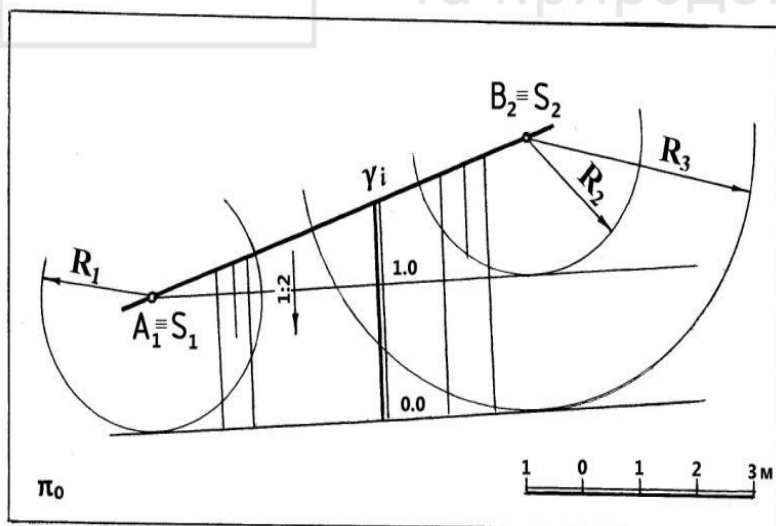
Градування площини земляного укосу γ з ухилом 1:2, що прилягає до прямолінійно нахиленої бровки (пряма АВ). План
